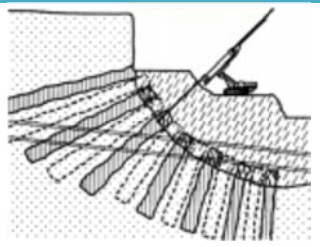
Exemplos de aplicação de jet grouting [25].
